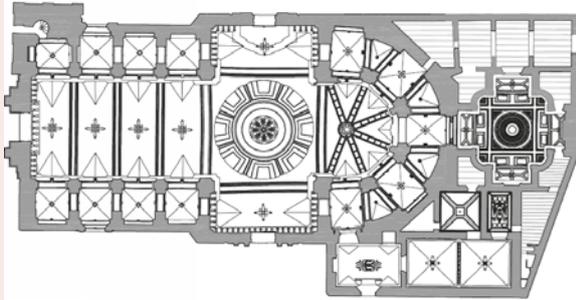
Planta actual de la Basílica de Santa María de Elche.
